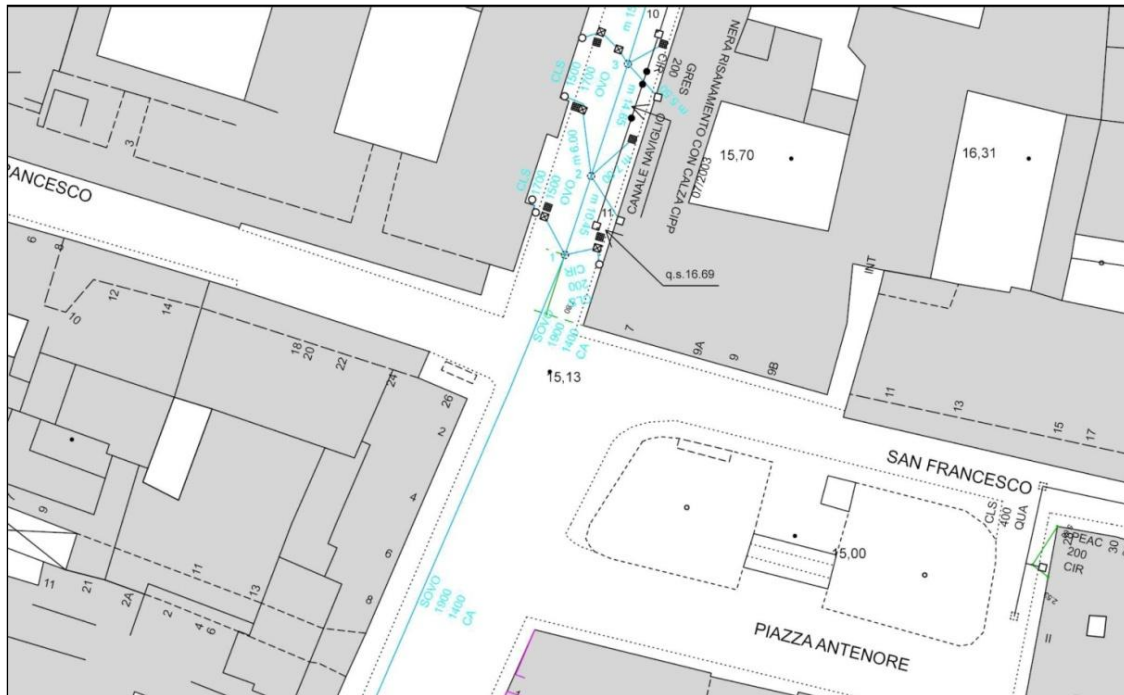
Planimetria con la rete fognaria (AcegasAps).
